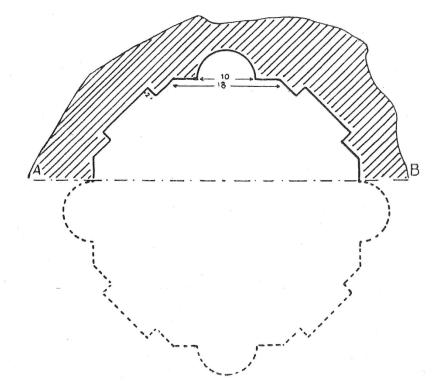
Plan général des travaux au Quer al-Salâm.
